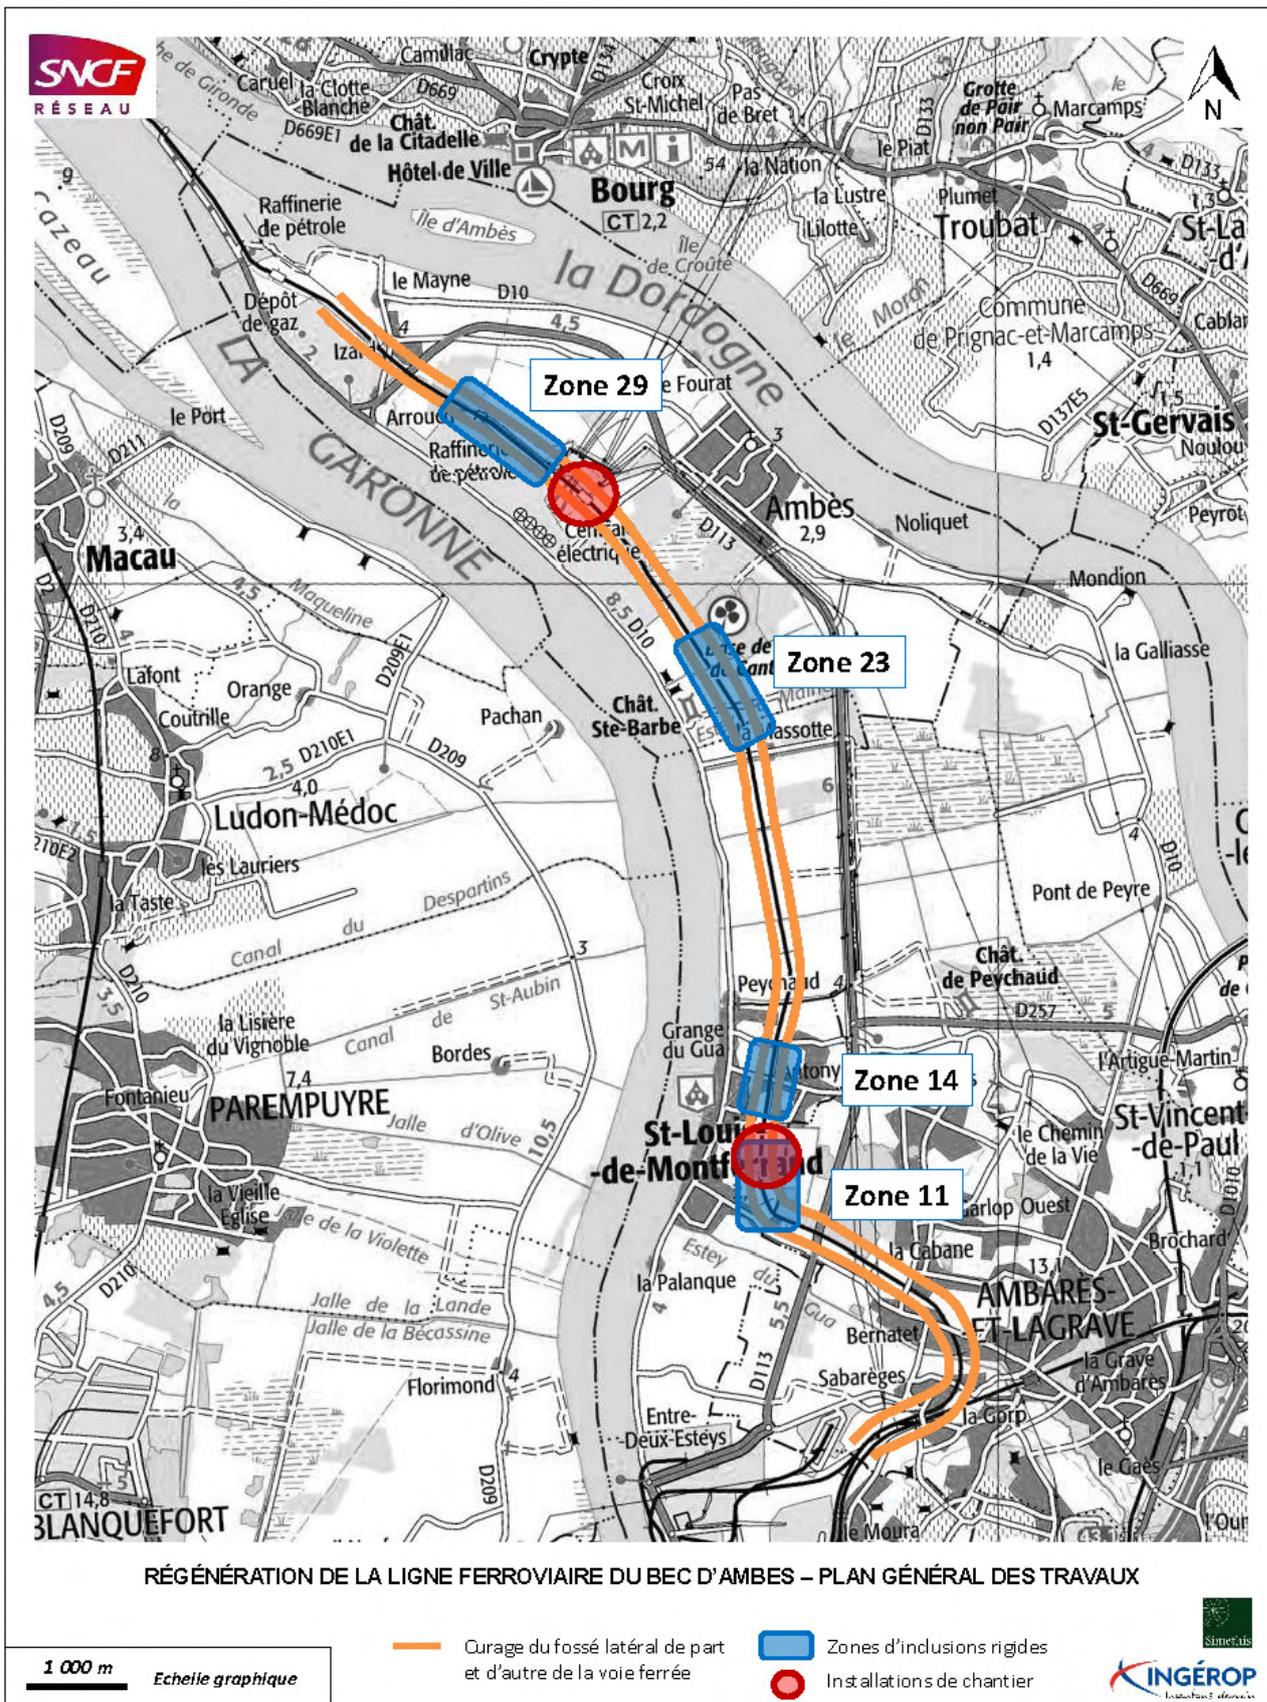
Plan général des travaux prévus sur la ligne (Source SNCF Réseau)
